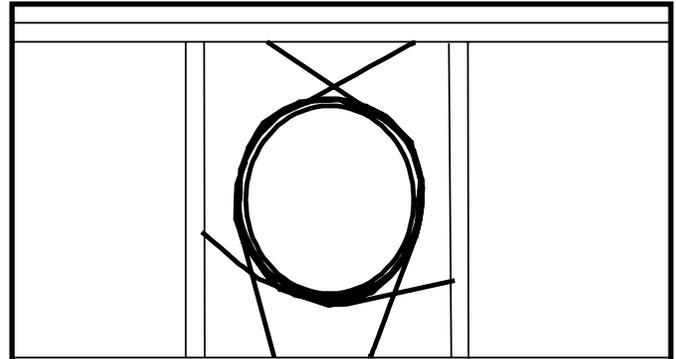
Sujeción de las secciones verticales del tubo de escape
